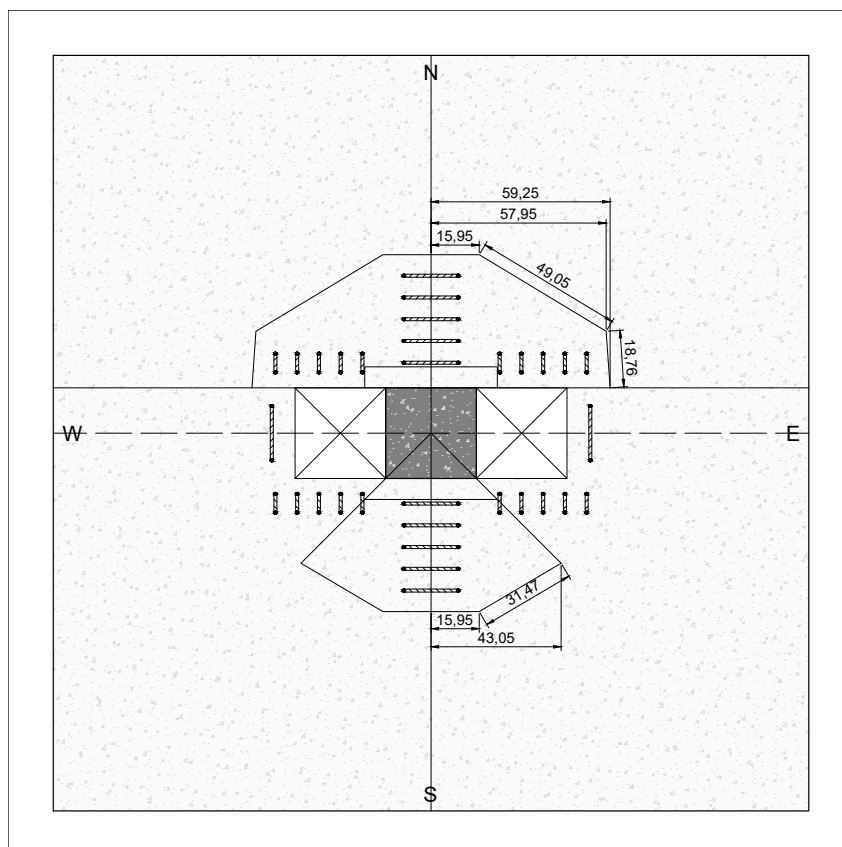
Perímetros externos segundo ACI 318-19 da laje LFE2
